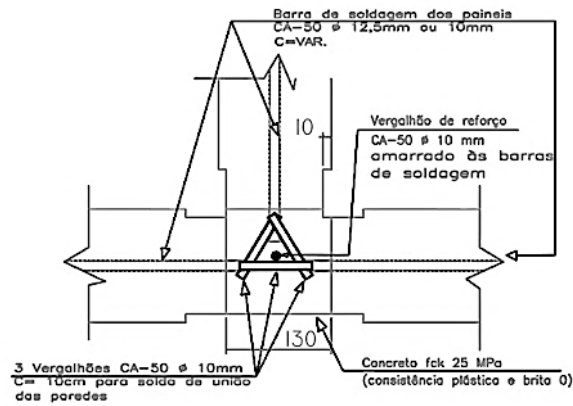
Detalhe esquemático da ligação entre três painéis.
